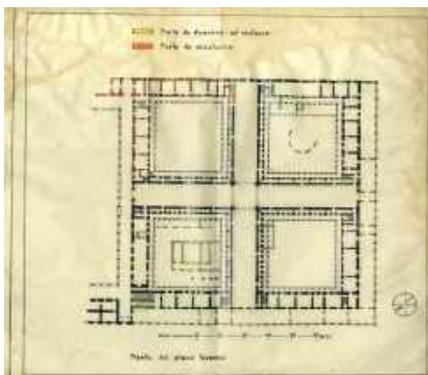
Cortili filaretiani, pianta piano terreno, progetto di restauro (giallo-demolizioni, rosso-ricostruzioni); tavola su lucido
